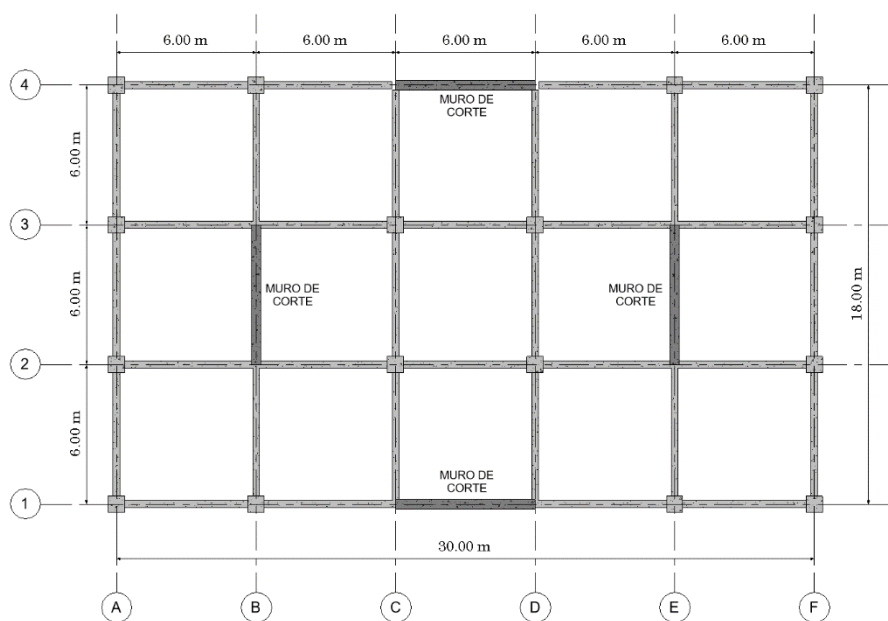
Distribución en planta Edificio Tipo 1 y 3
